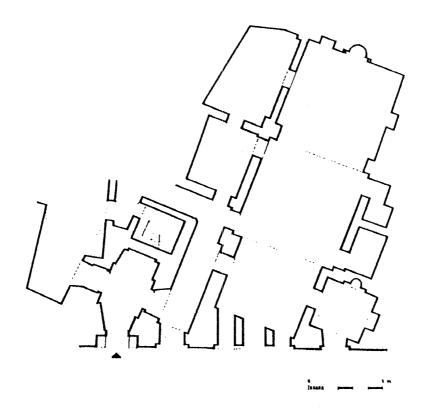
مسقط أفقي لجامع البرديني بالقاهرة .
